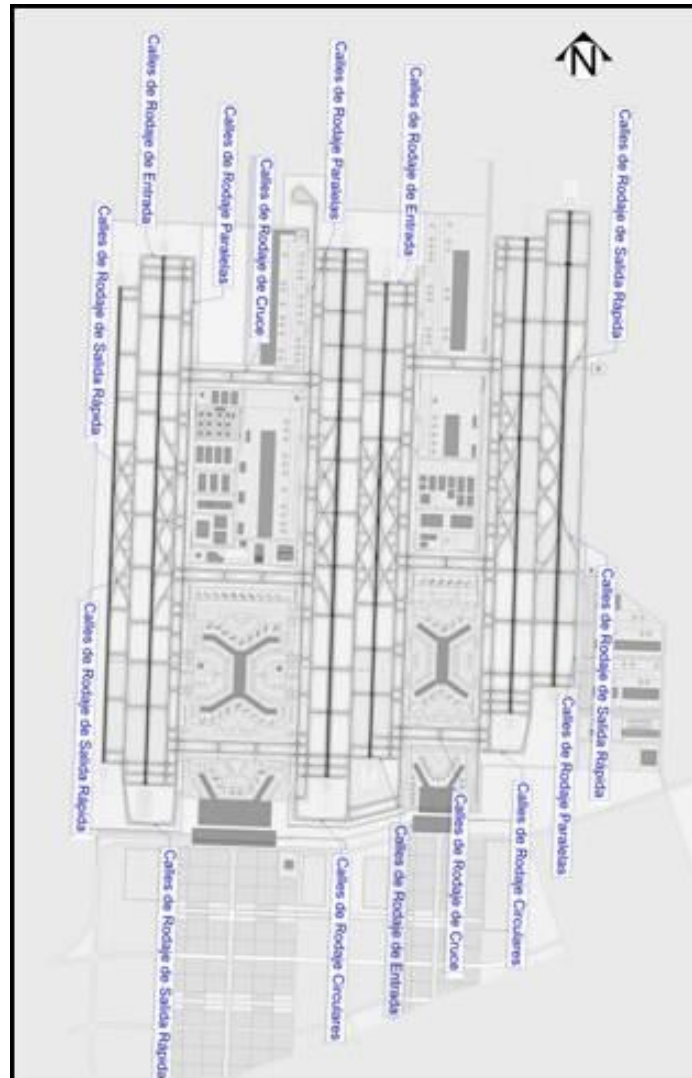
Diseño de calles de rodaje y calles de acceso.
